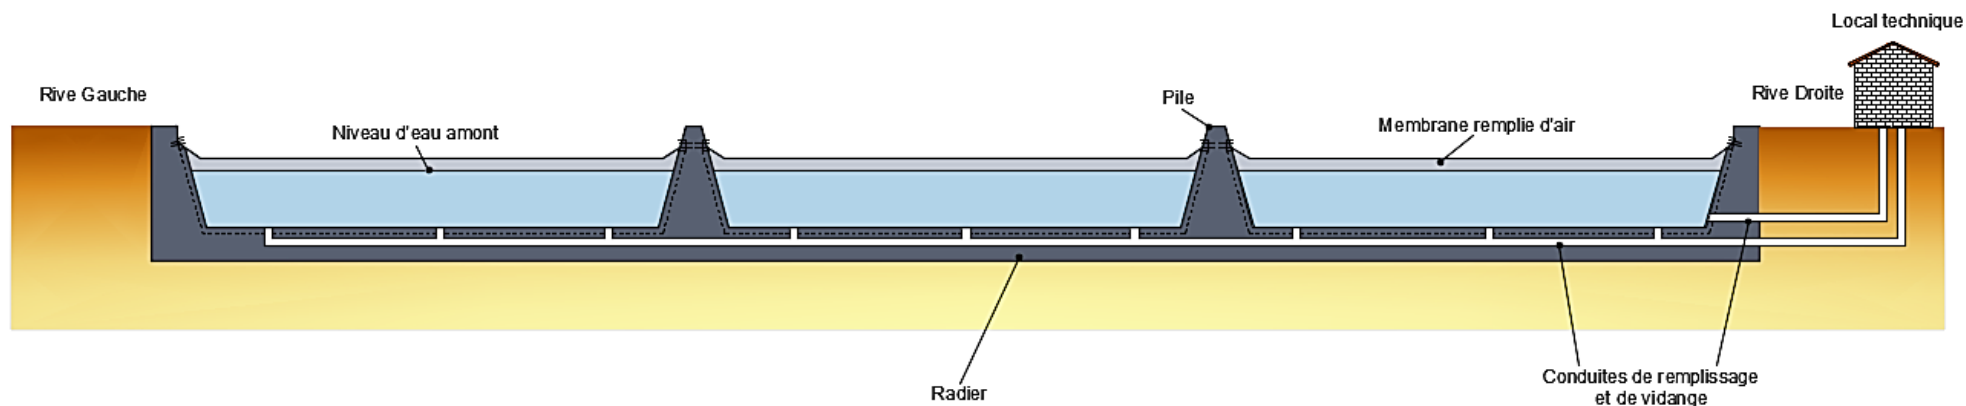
Schéma d'une coupe longitudinale du barrage gonflable
